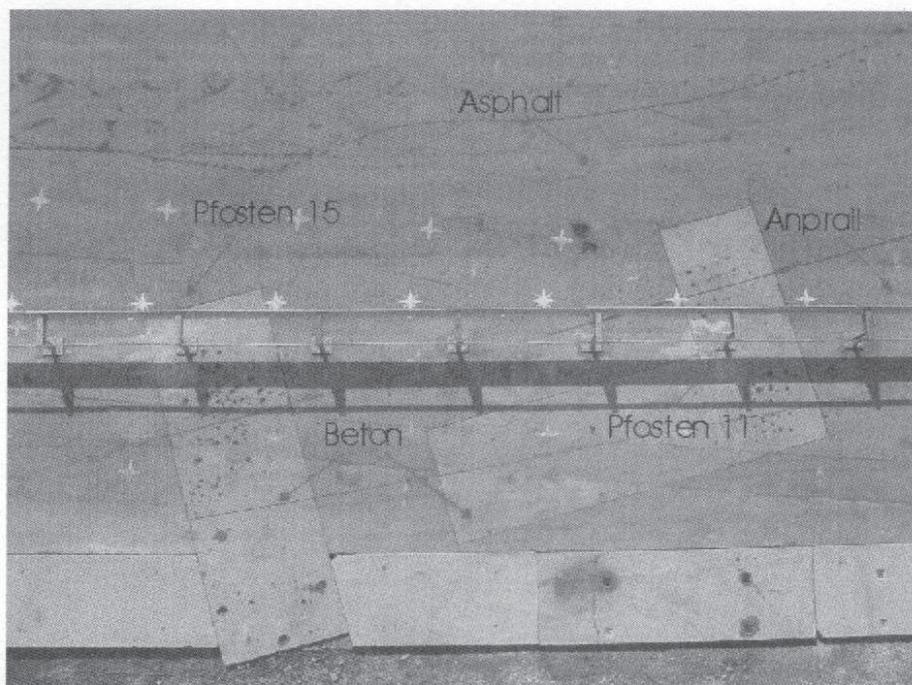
Anprallbereich auf wechselndem Untergrund
